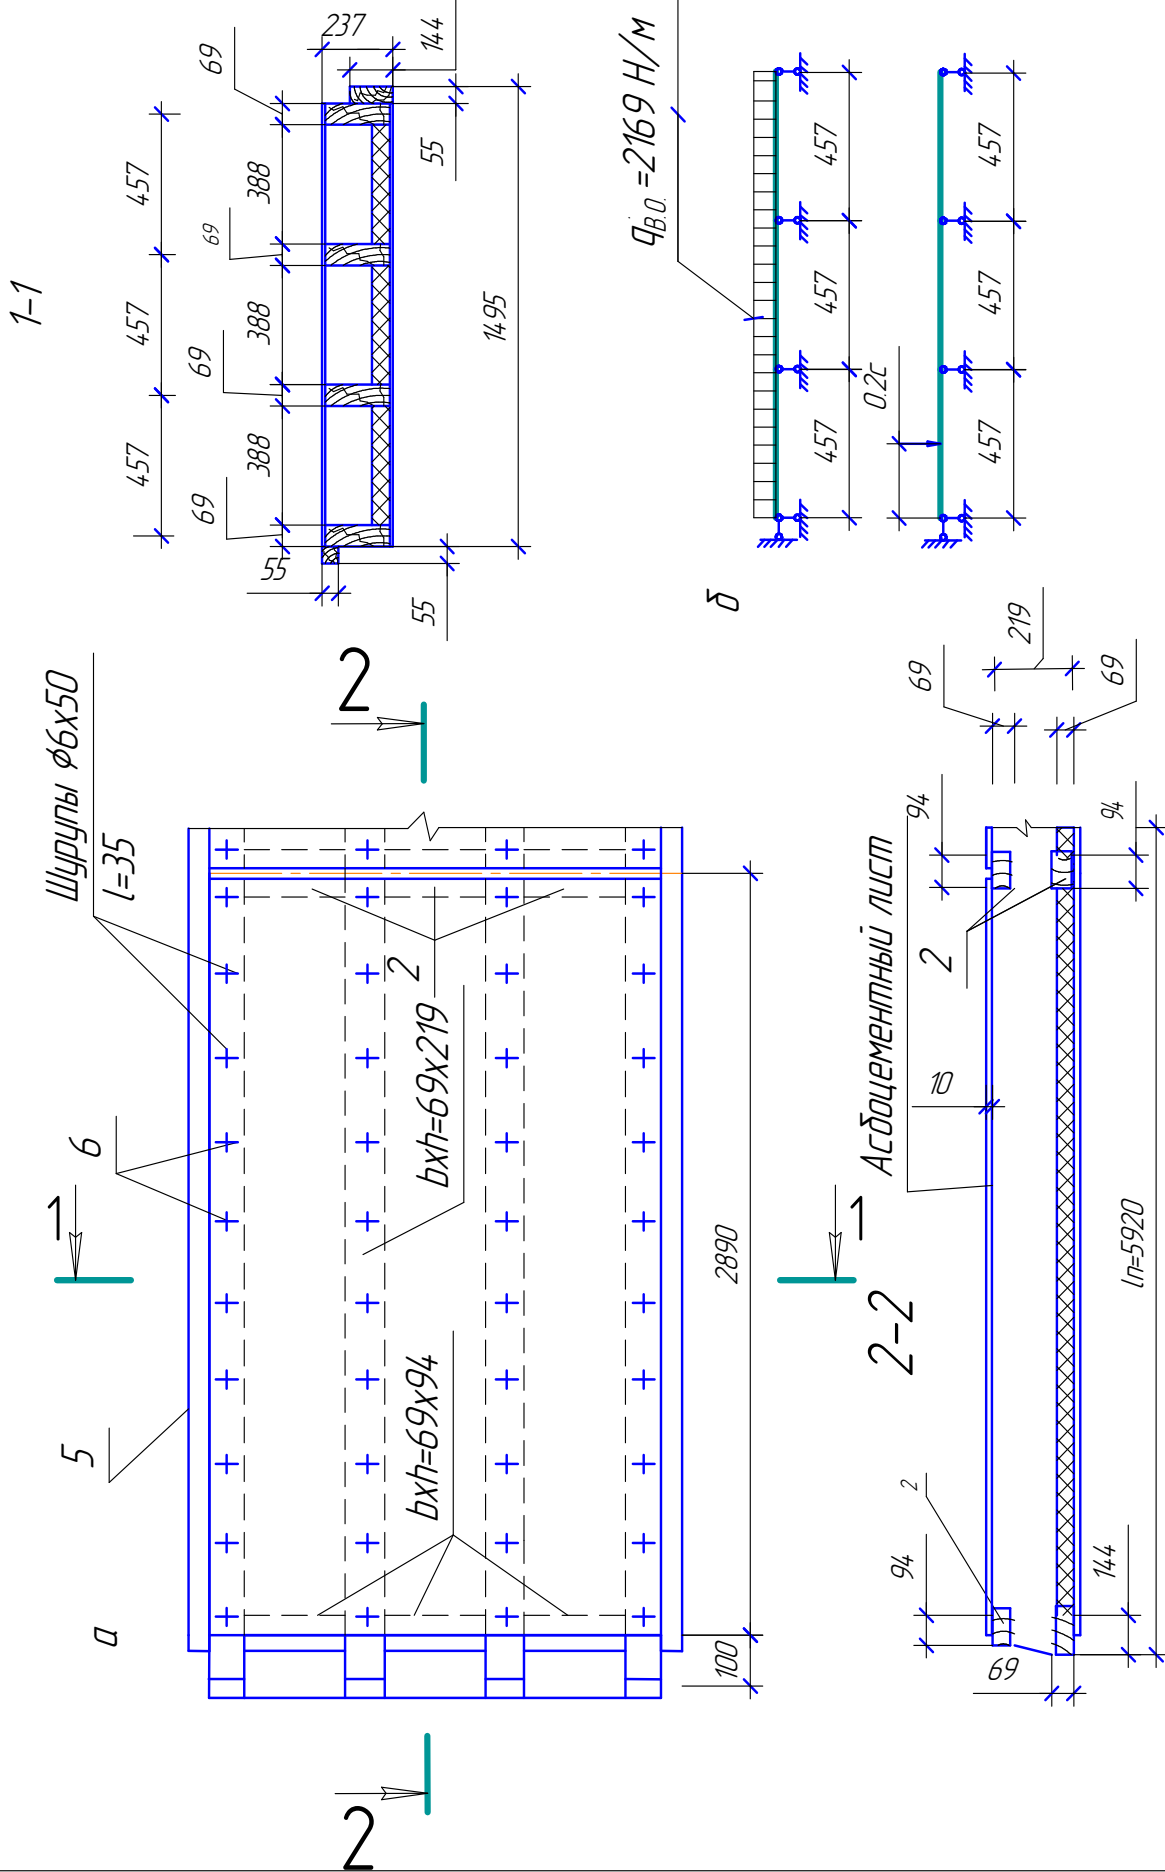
Утепленная плита с асбоцементными обшивками (а) и расчетная схема верхней обшивки (δ).
